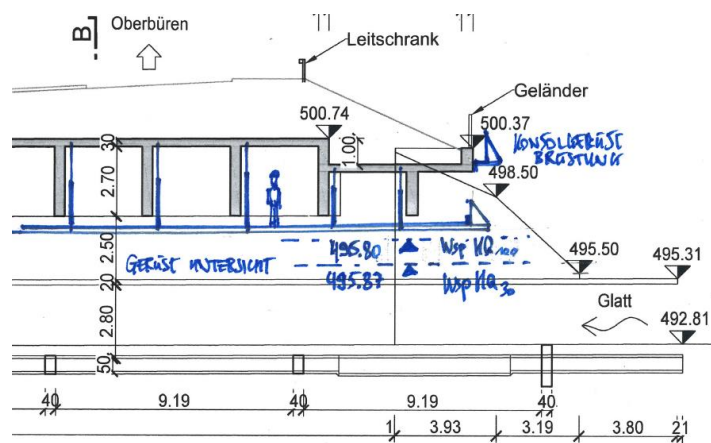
Längsschnitt mit Gerüst Untersicht und Konsolgerüst Brüstung
